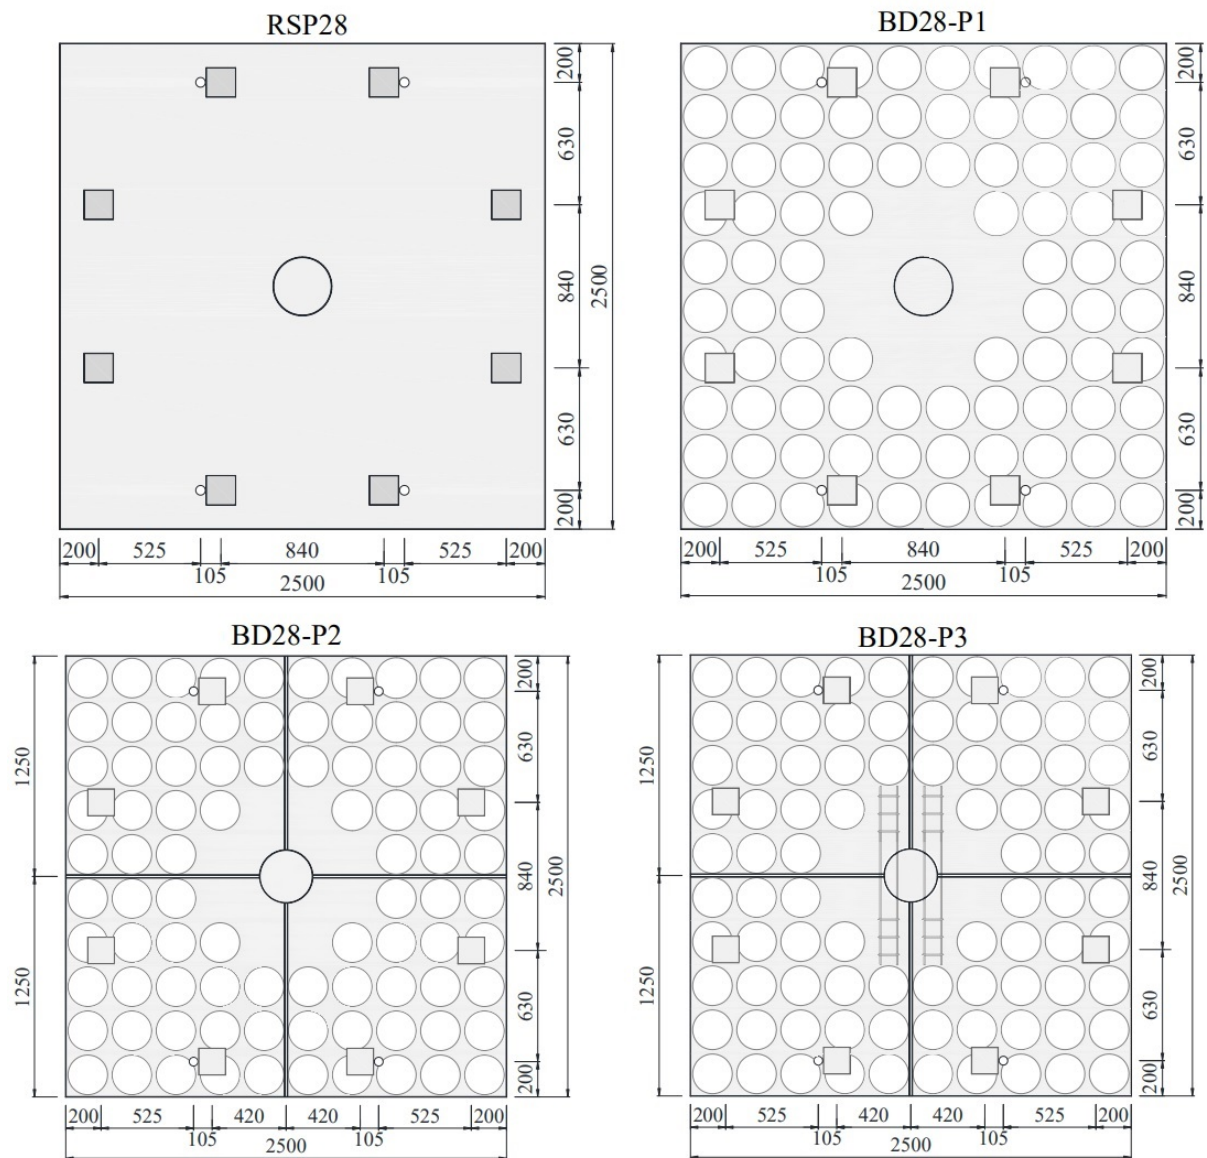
Lajes da primeira série de concretagem (dimensões em mm) (fonte: Nicácio (2018))
